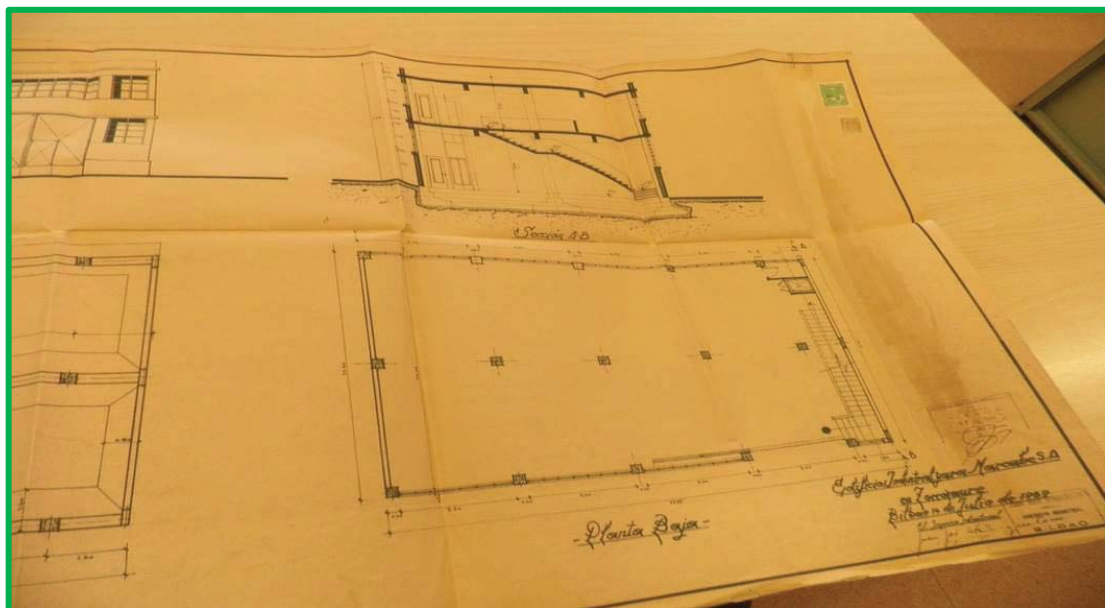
Planta baja de la nave edificada en Marcabe, año 1959
